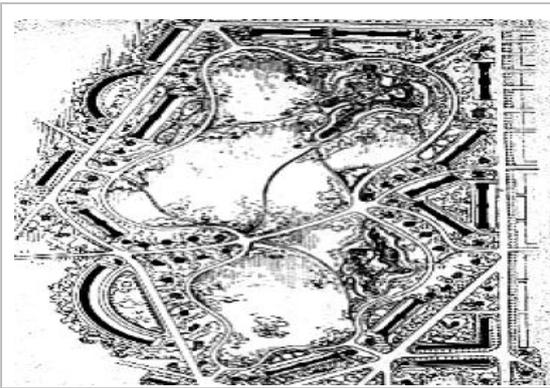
Planta do Birkenhead Park, Inglaterra, 1843
